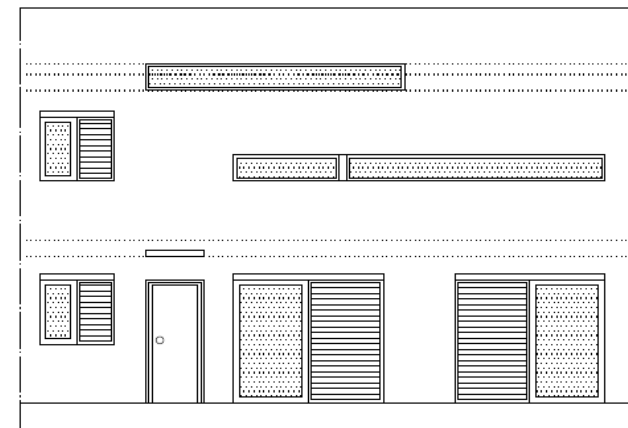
8 – Fachada norte da casa ES *Passivhaus* proposta
